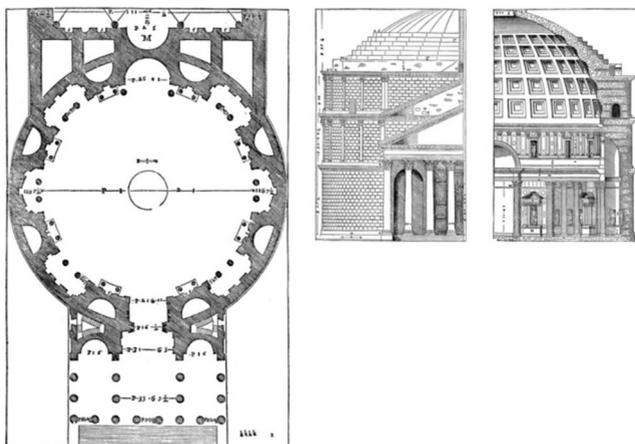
Andrea Palladio: Pantheon in Grundriss, Ansicht und Schnitt (1570)
